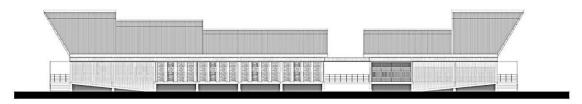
Fachada norte del Centro de Capacitación Indígena Entre Nos Atelier por el Arquitecto Adolfo Mejía. S/E. Fuente: http://www.archdaily.mx/
